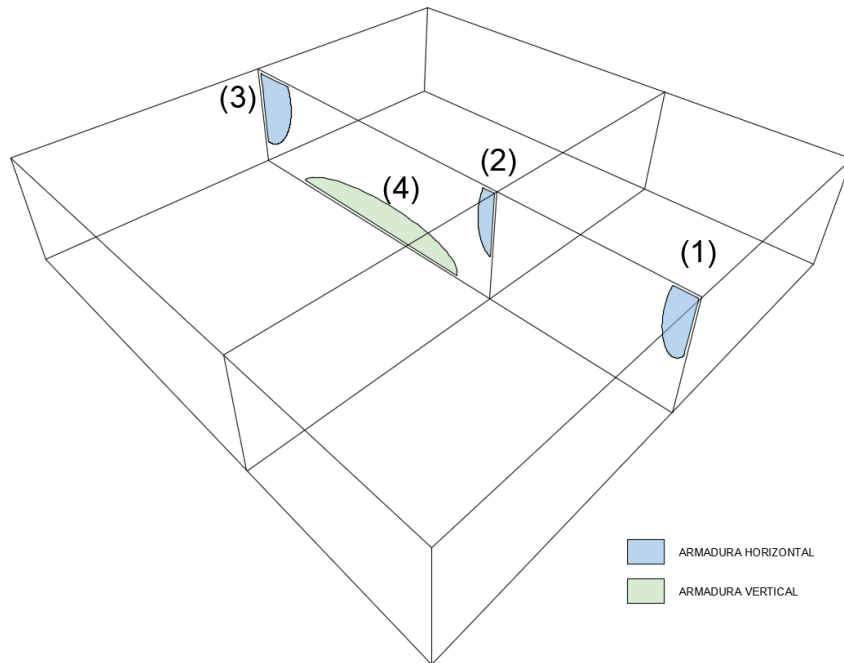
Comprobación de fisuración en zonas de refuerzo en muros internos
